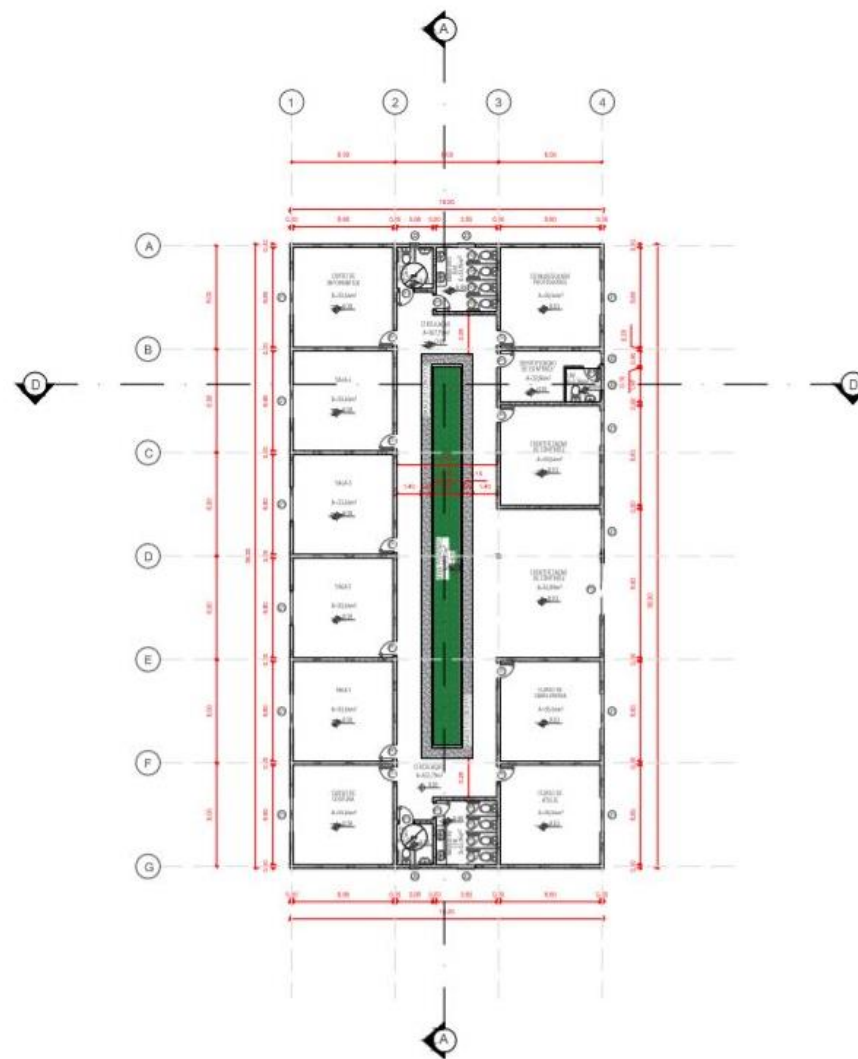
Planta Técnica – Fonte: Acervo Próprio
